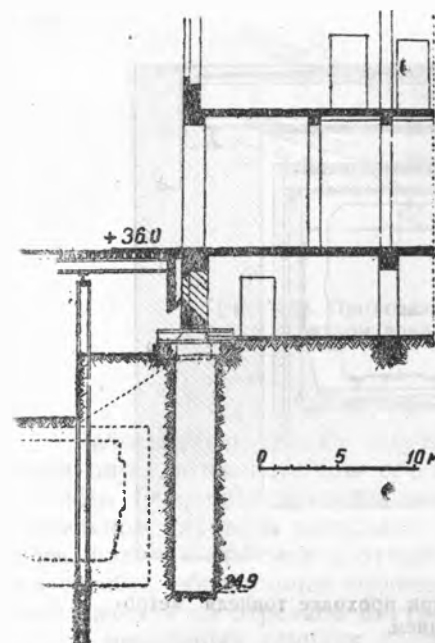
Подводка сплошного фундамента под фасадную стену дома в связи с сооружением тоннеля в открытом котловане вблизи дома.
